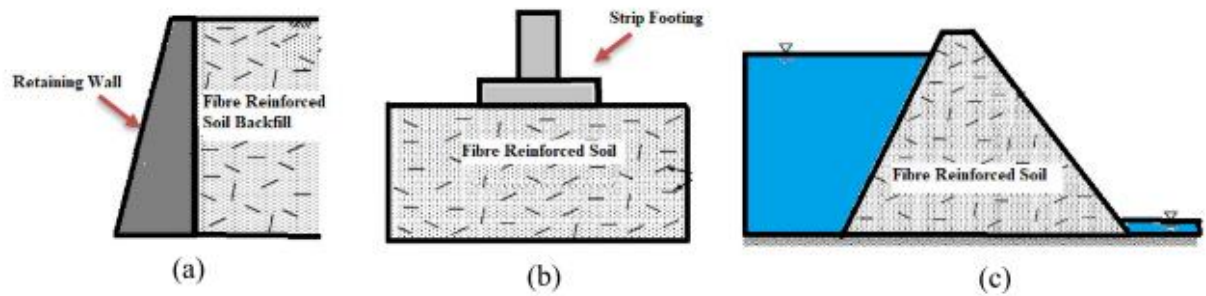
18: Applications du sol renforcé par des fibres : (a) un mur de soutènement, (b) une semelle isolé, (c) un barrage de type « digue » (petit barrage construit en travers d'un bassin de rétention, d'une rigole ou d'un canal pour réduire la vitesse de l'écoulement).(Safdar et al., 2022)
